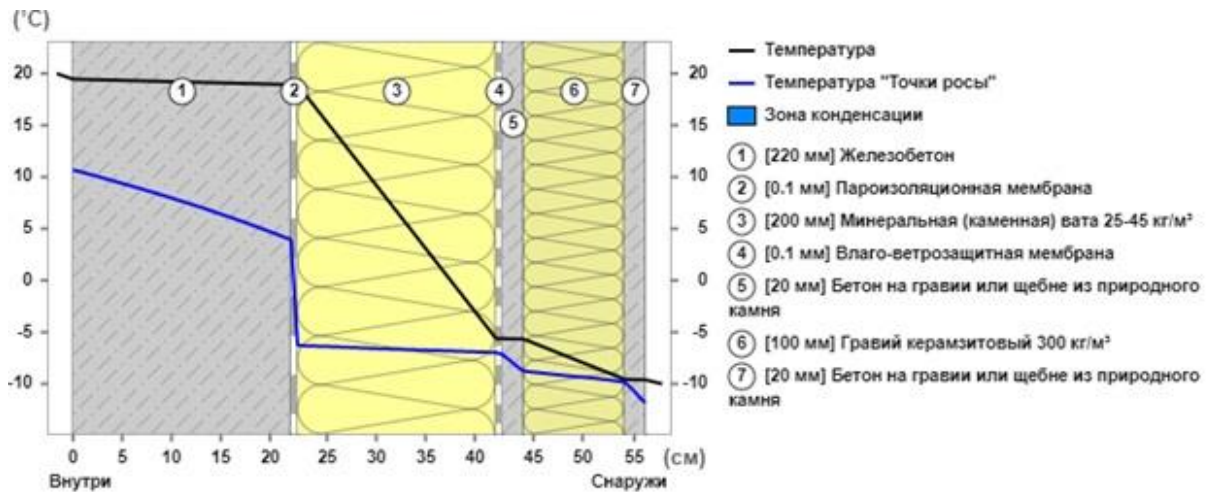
Конструкція перекриття неопалювального горища після утеплення
